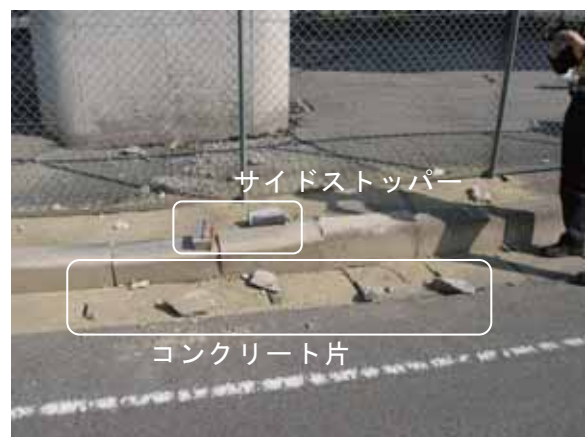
落下したコンクリート片とサイドストッパー
